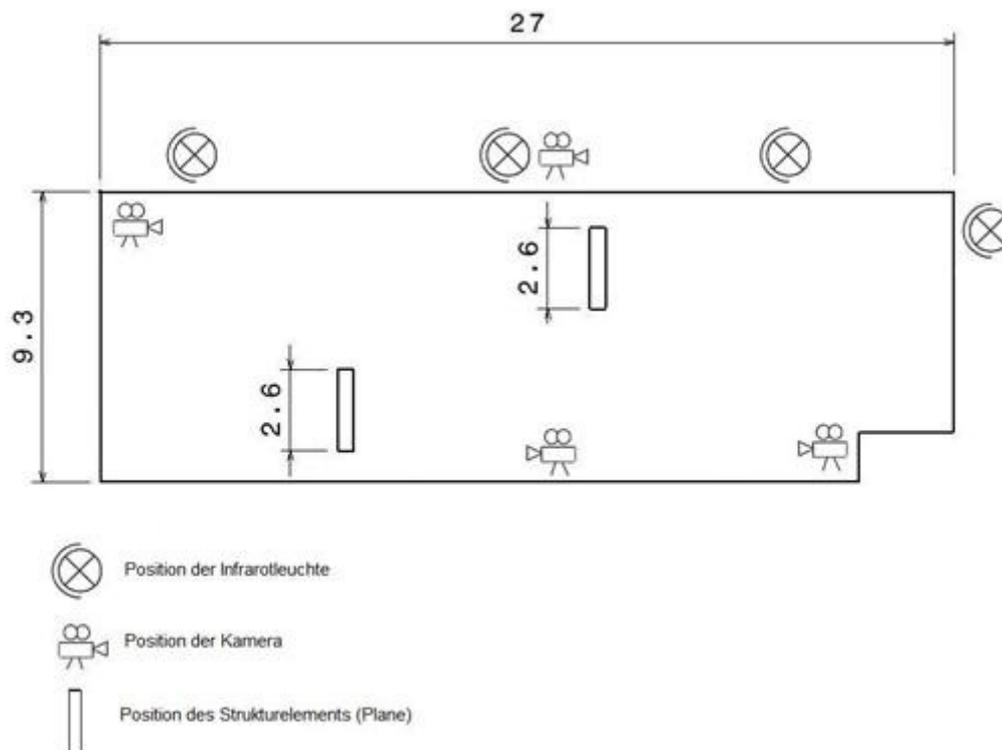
Grundriss Stall 1 (inkl. Strukturelementen, Kameras und Infrarotstrahlern; Angaben in m)
